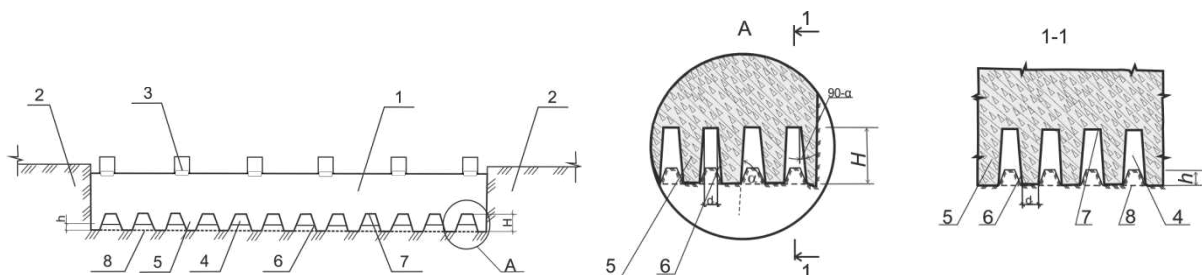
Конструкція плитного фундаменту-саморегулятора для будівель та споруд: 1 – фундамент; 2 – ґрунт; 3 – опора; 4 – пірамідальна порожнина; 5 – опорні призматичні ділянки; 6 – бічна грань; 7 – верхня основа призми; 8 – лист пружного піддатливого матеріалу
